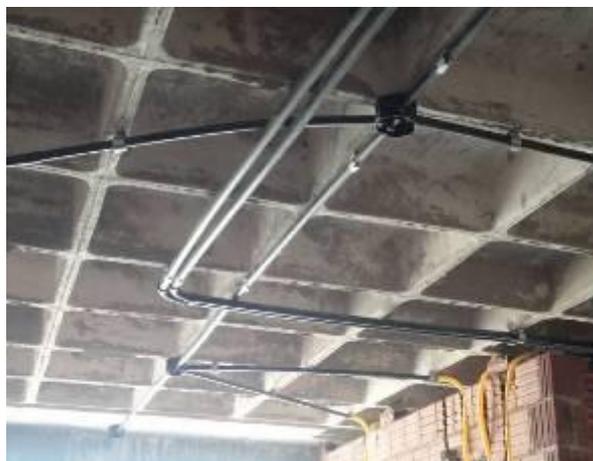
Ligação dos eletrodutos flexíveis com os rígidos (superestrutura)
